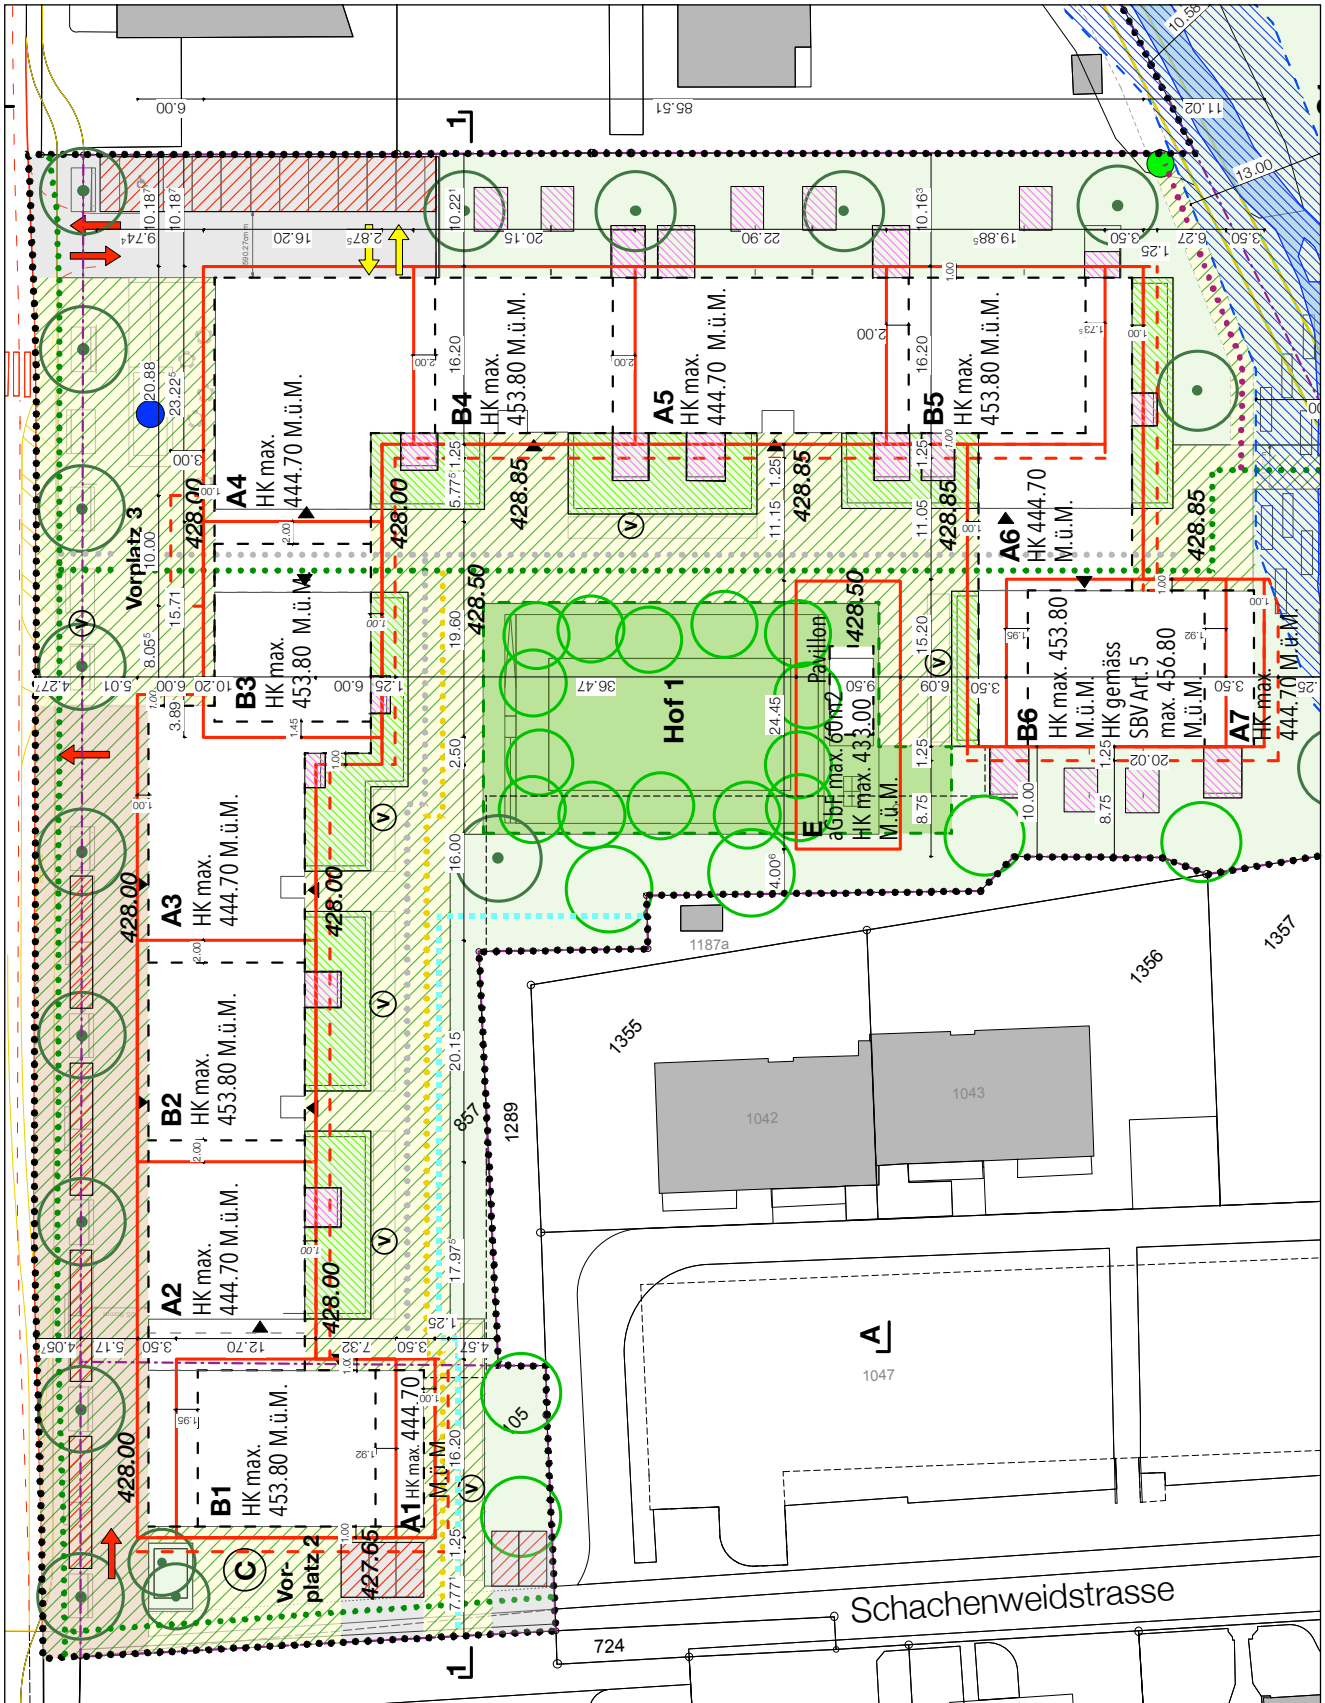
Ausschnitt des Situationsplans 1:500 Bebauungsplan Sagenmatt mit den Baufeldern A1-A7 und B1-B6
